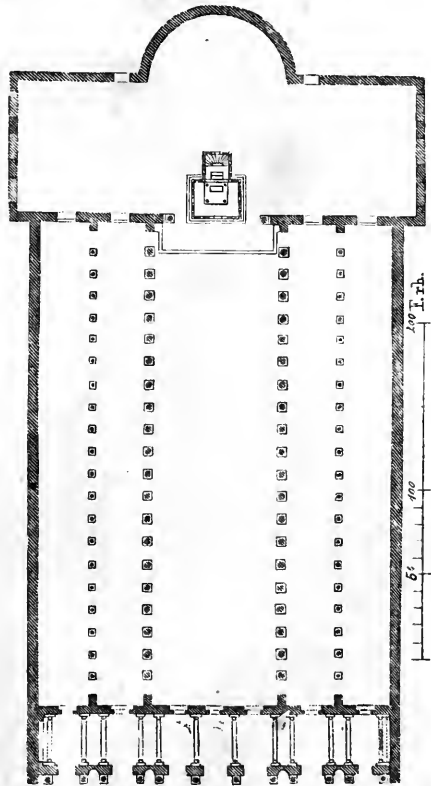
Grundriss von St. Paul bei Rom.
